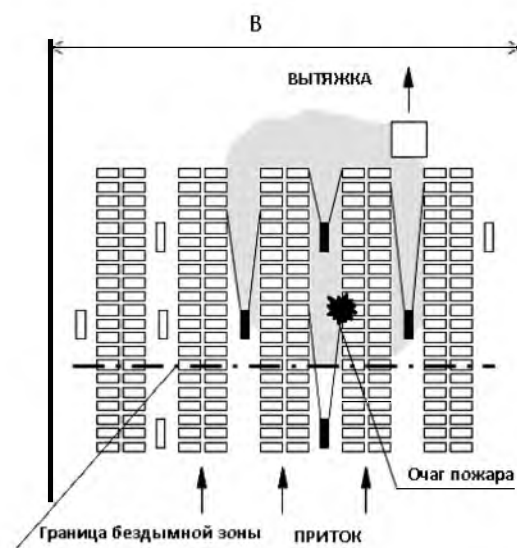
Схема включения струйных вентиляторов в районе очага пожара при продольной схеме дымоудаления
